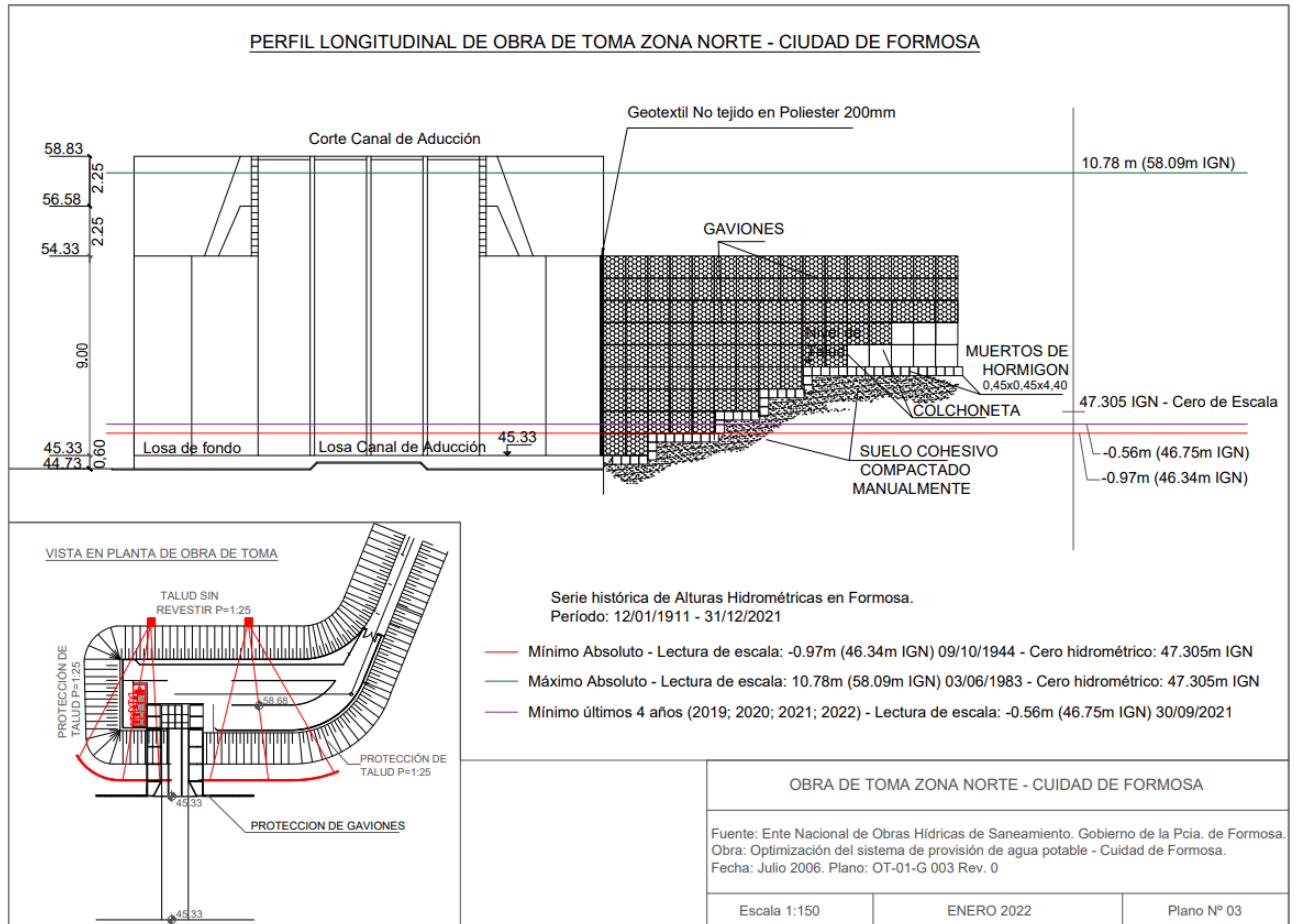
Planimetría y Perfil longitudinal de la Toma Zona Norte con cotas de referencia – Ciudad de Formosa
